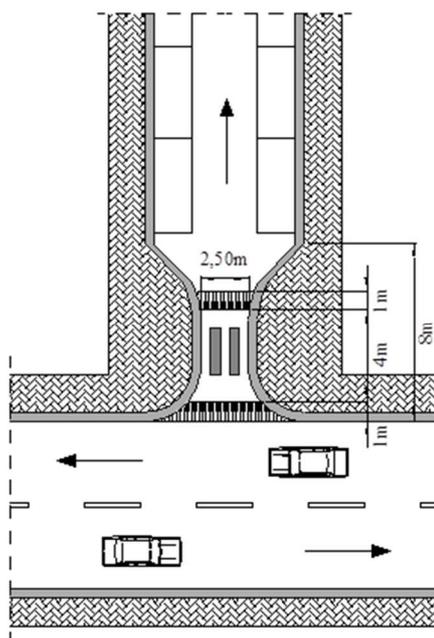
Esempio di restringimento con platea rialzata su accesso a strada locale
